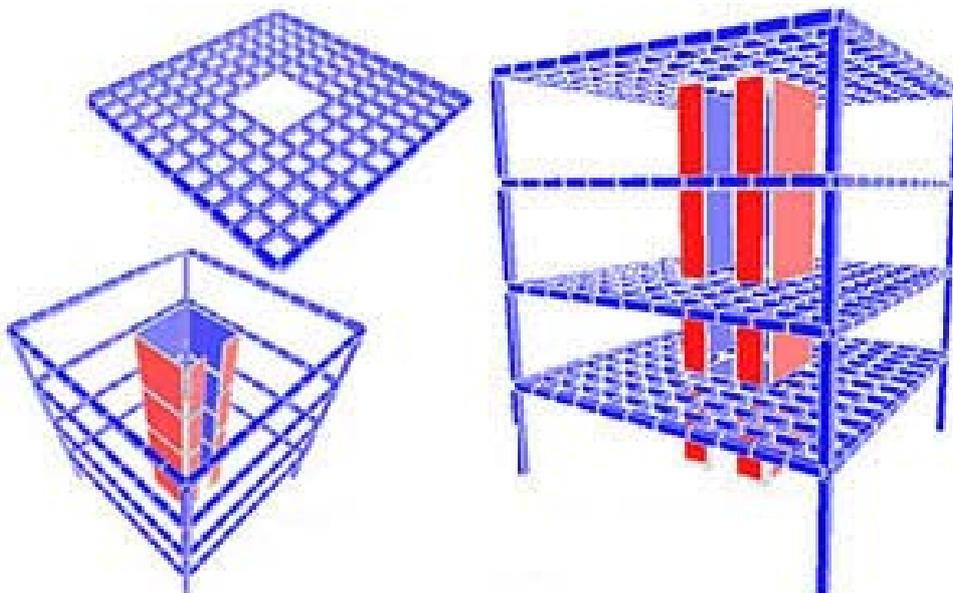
Composição dos sistemas estruturais de edificações elevadas pelo subsistema horizontal e vertical [26]
